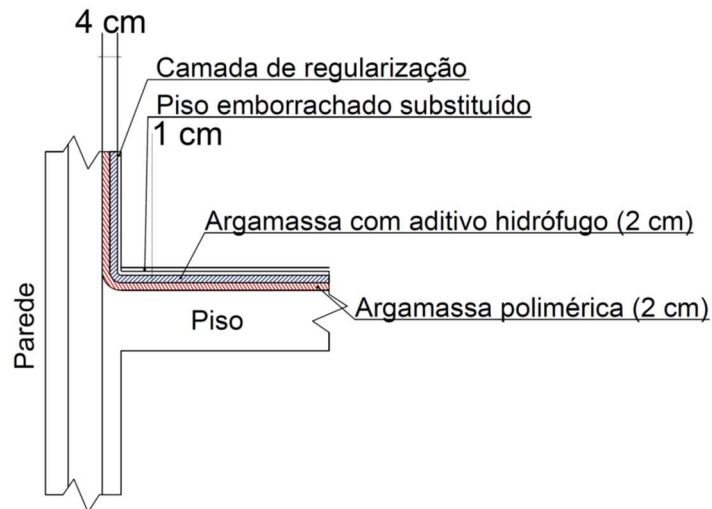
Detalhe em perfil dos elementos construtivos atualmente
